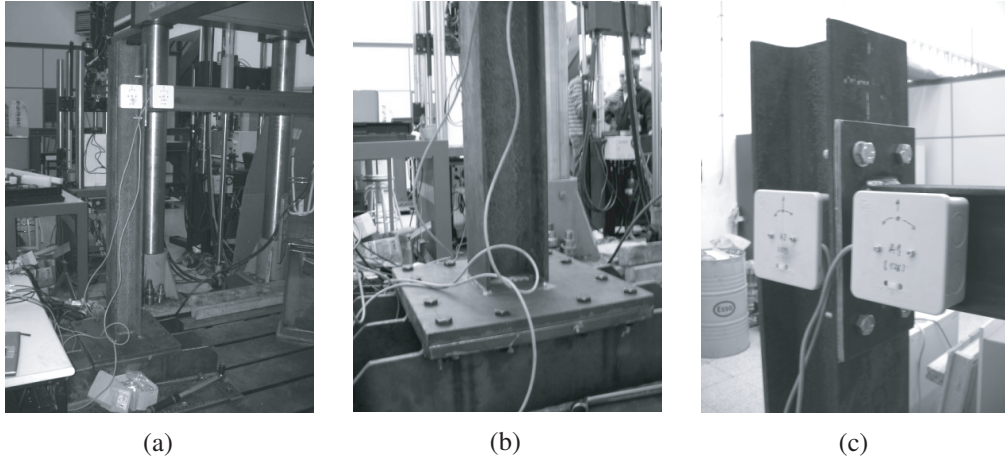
Equipamiento. (a): Vista general. (b): Pilar. (c): Unión y los dos inclinómetros.
